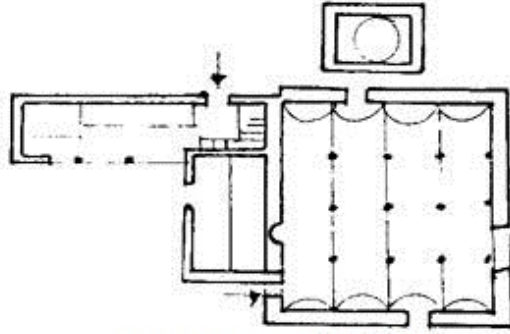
المسقط الأفقي لمسجد وزاوية المنتصر (عن مسعود البلوشي)
